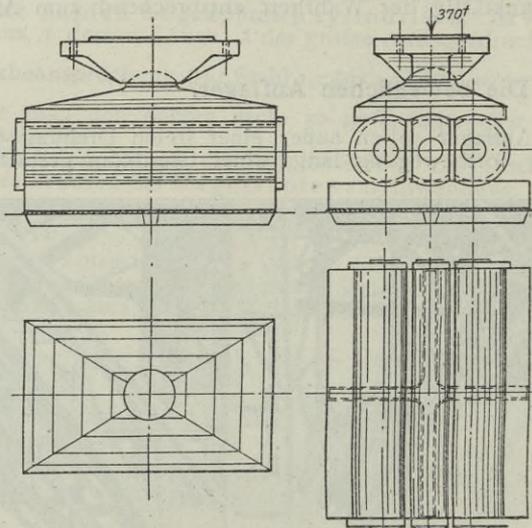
Bewegliches Lager der Stubenrauch-Brücke in Niederschöneweide.
